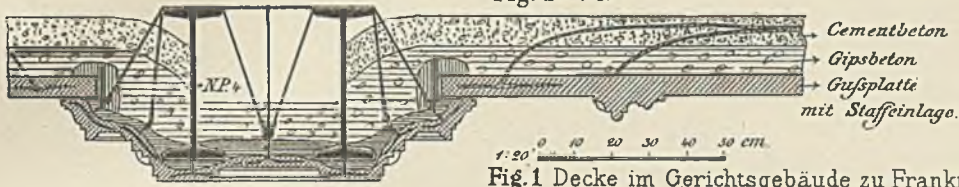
Decke im Gerichtsgebäude zu Frankfurt a. M.
